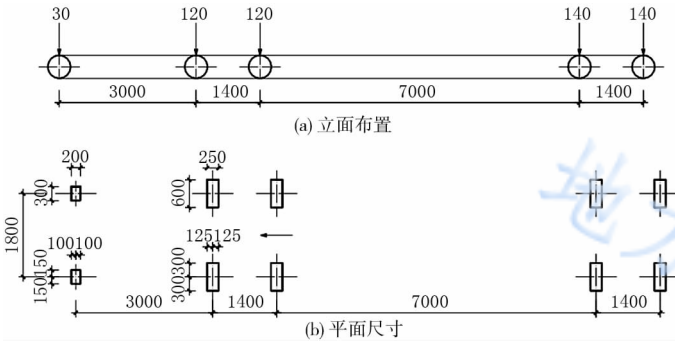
城-B 车辆荷载的立面、平面尺寸示意图
